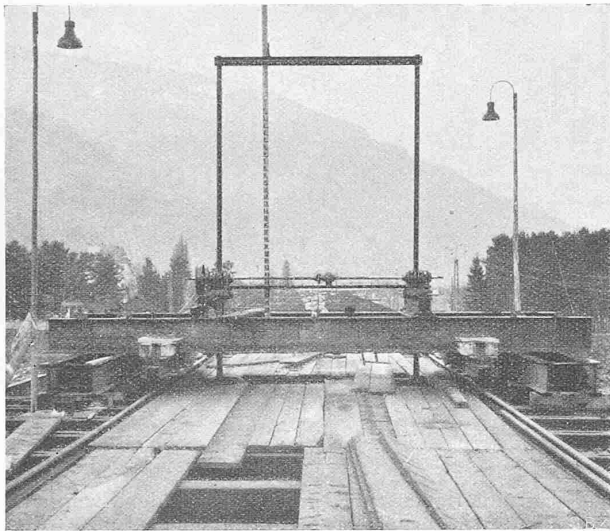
Absenk-Vorrichtung auf der alten Dachbalkenlage.
